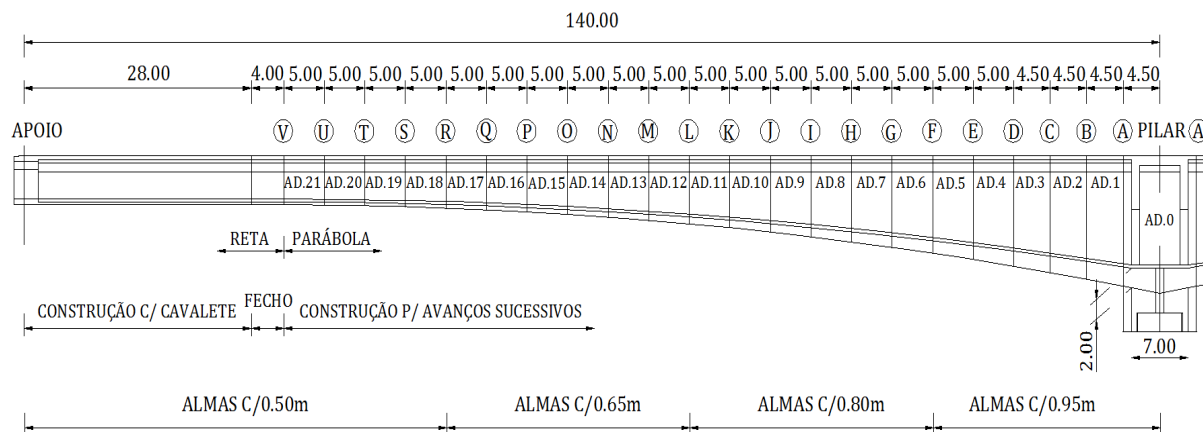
Corte longitudinal pelo eixo - vãos extremos 140,00 m (caso de estudo 6)
